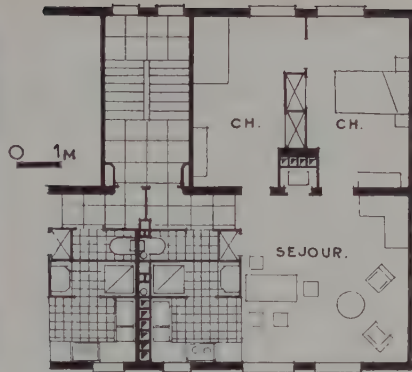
Großblockgrundriß aus Paris (Argenteuil). Architekt Fontaine. Siporexblöcke 25-15 cm dick, je nach Geschöß, fünf Stück auf eine Etagenhöhe. Zentralumlufttolen für alle drei Zimmer
